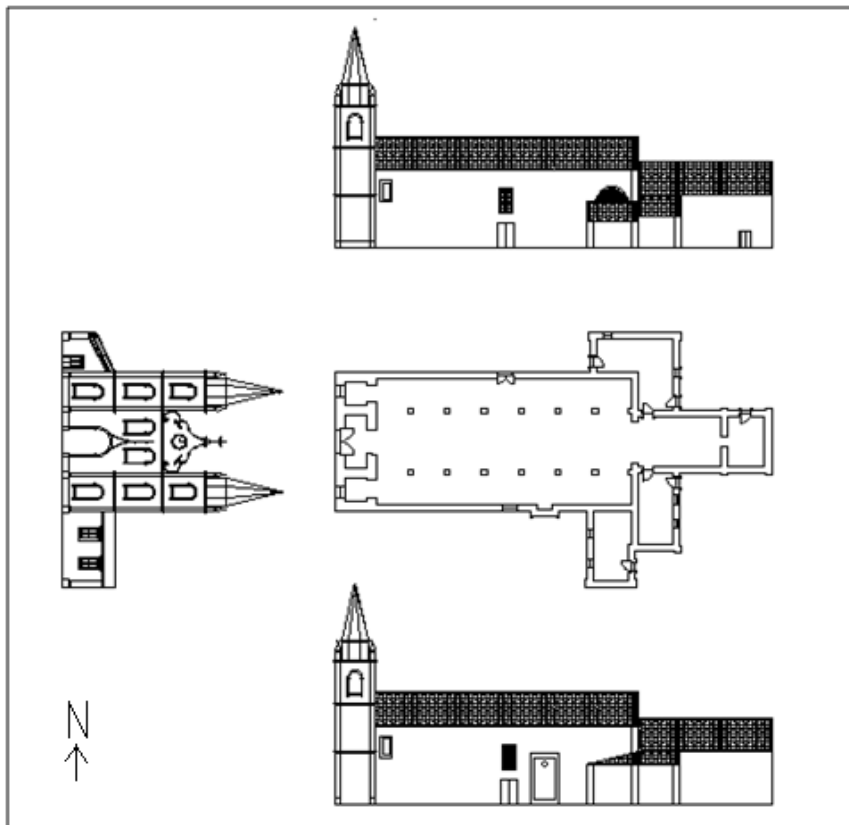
Planta e alçados da igreja Santa Maria Madalena.
